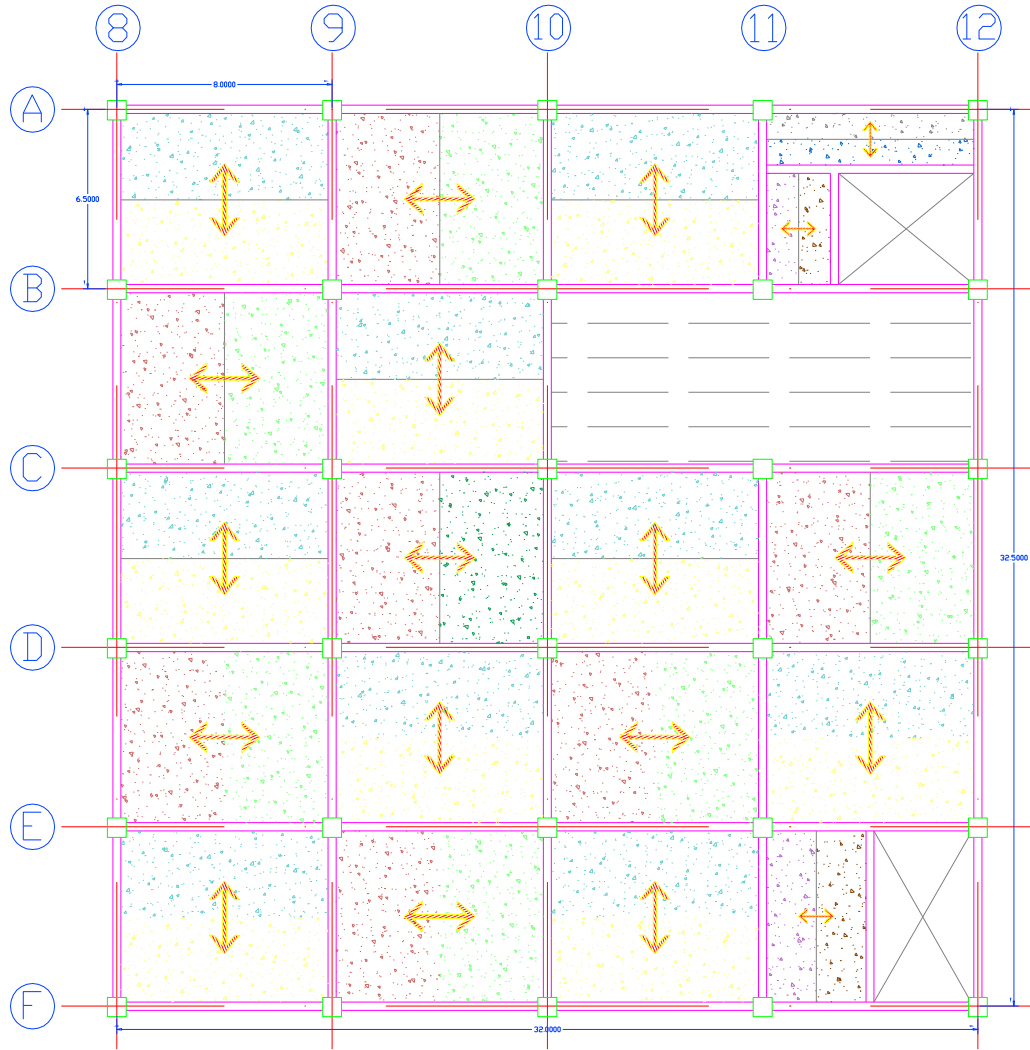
Distribución de las losas de entepiso para la planta principal
